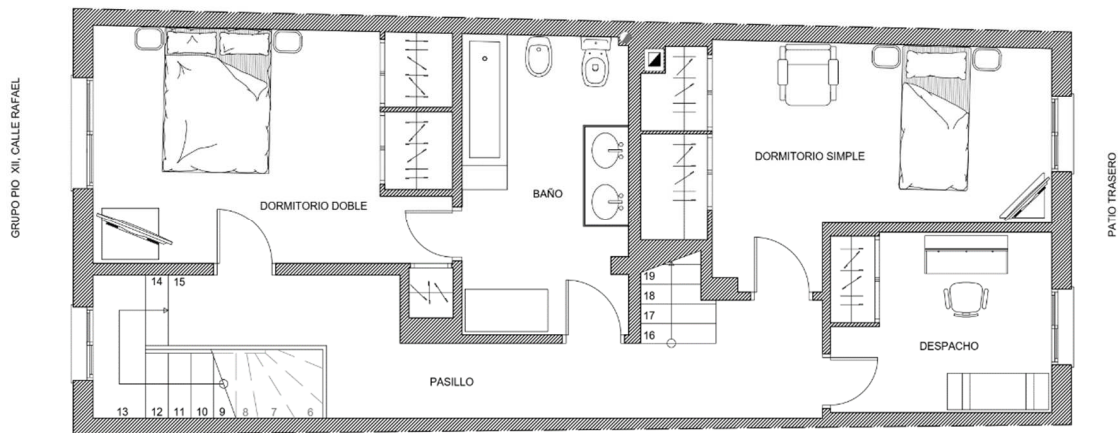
Planta primera AutoCAD. Fuente propia programa AutoCAD
